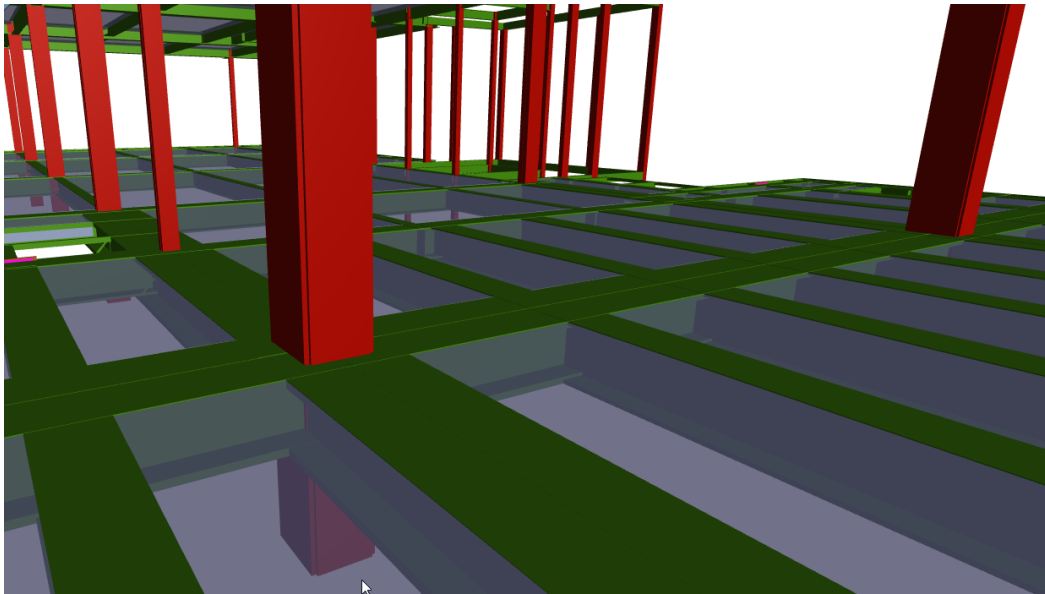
Zona de unión entre pilar P33 y dos vigas doble HEM320 soldadas en cajón, vista 3D en CYPECAD.
